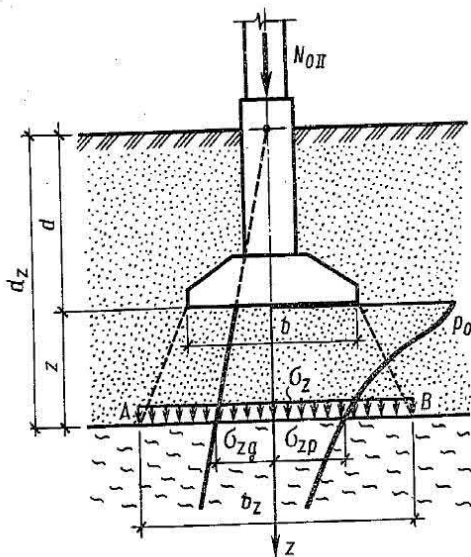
Расчетная схема к проверке давления на подстилающий слой слабого грунта
